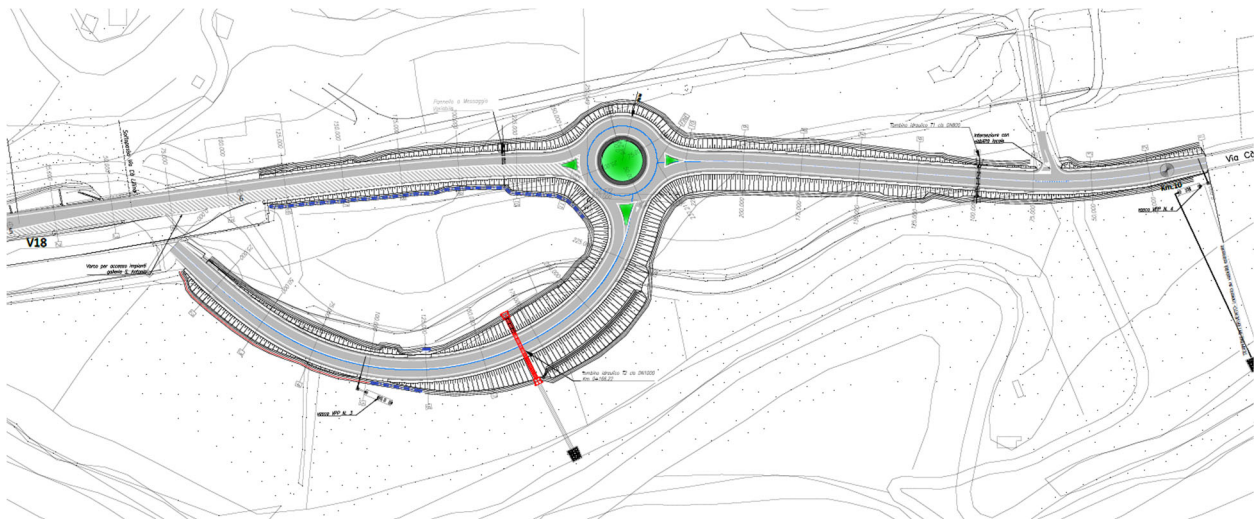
Collegamento alla viabilità esistente lato Marche – Progetto Definitivo
